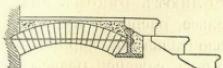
Кладка прусскихъ сводовъ подъ площадками лѣстницъ.
